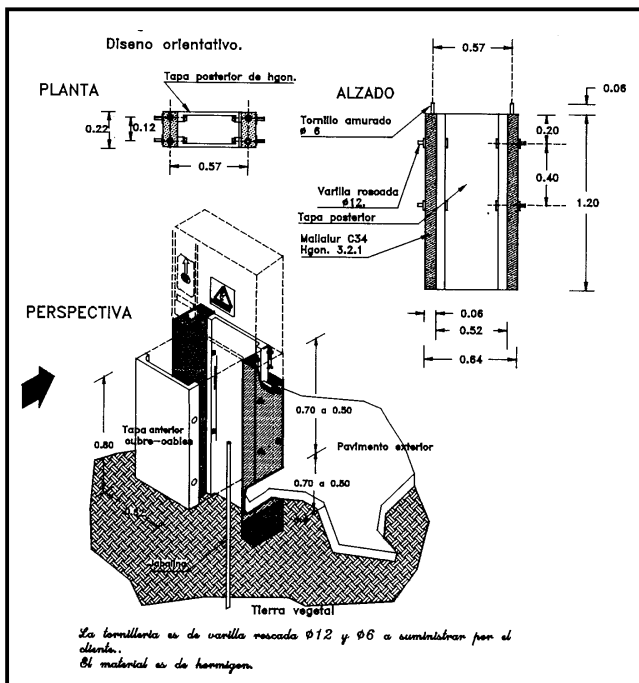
Esquema de armado de zócalo prefabricado para C.G.P. dentro del retiro.
